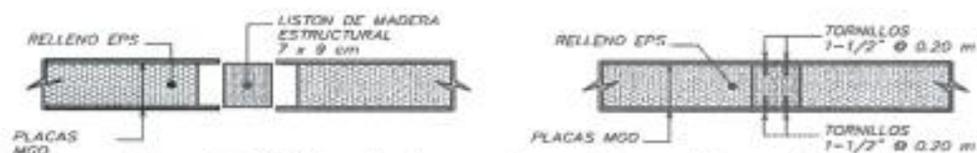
Unión entre dos paneles continuos, vista en planta
